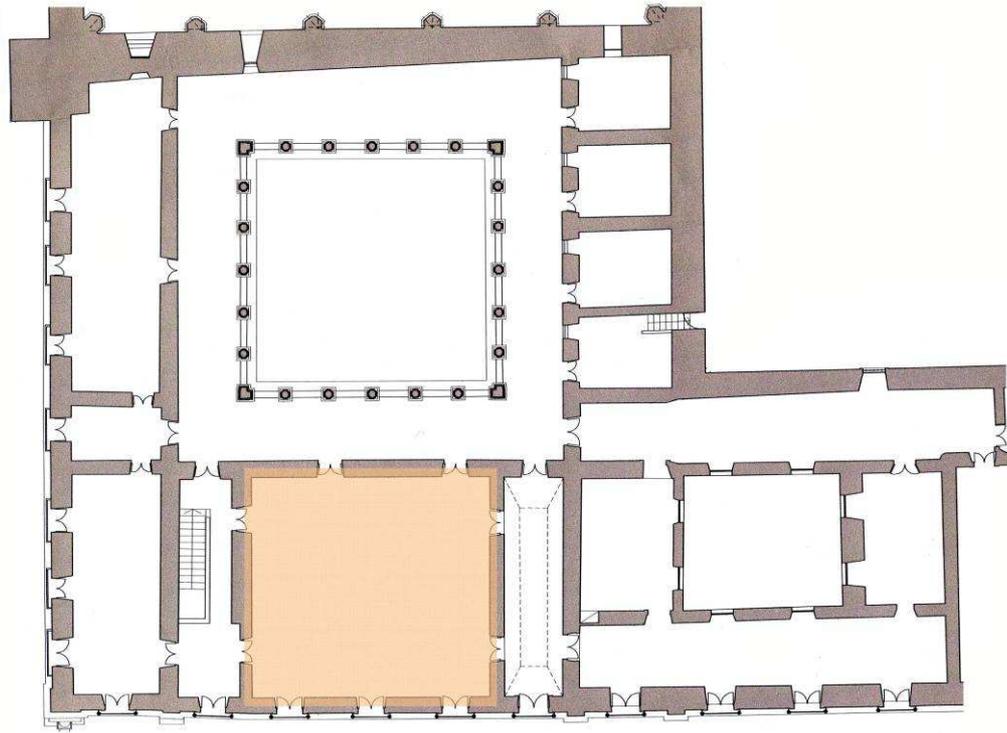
Localização da sala do centro na planta do piso superior do levantamento de 2003.
